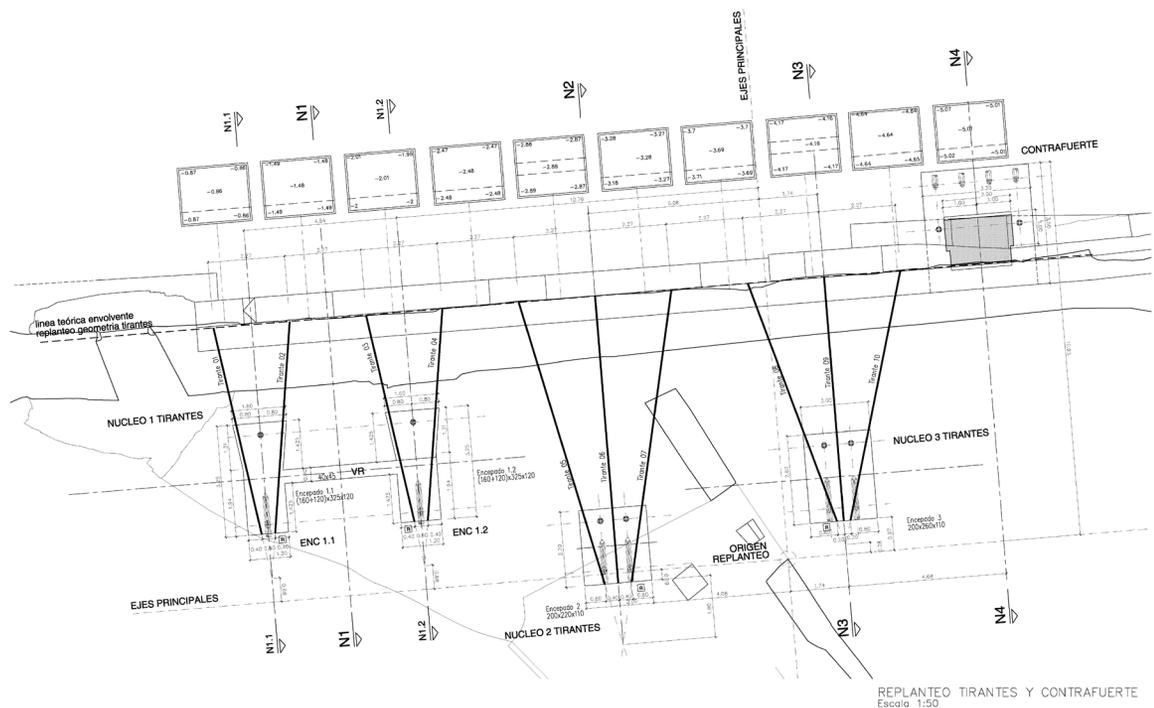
Planta de replanteo del sistema de tirantes desde el intradós y contrafuerte por el exterior de la muralla.
